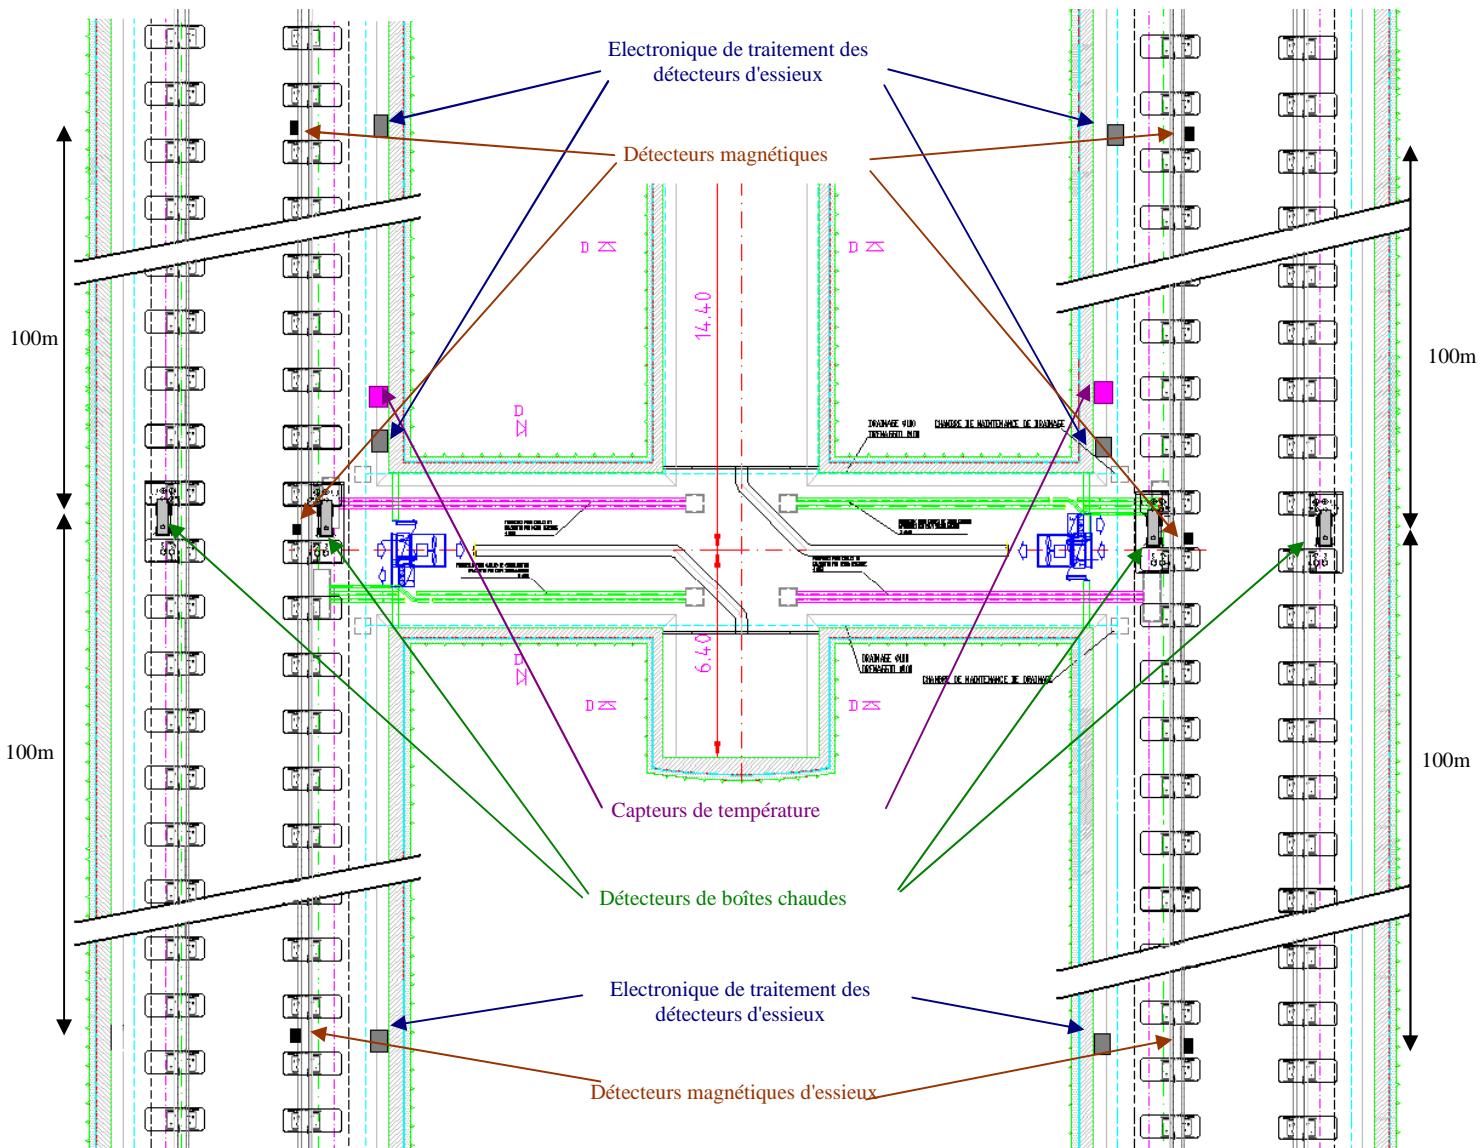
Plan d'implantation des capteurs pour le système de DBC en tunnel
